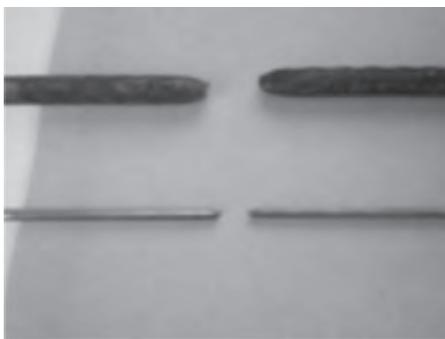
Falla de las barra de refuerzo por utilizar: La superior es la barra utilizada como refuerzo longitudinal. La inferior es la barra utilizada como refuerzo transversal. Se observa la falla dúctil del material
